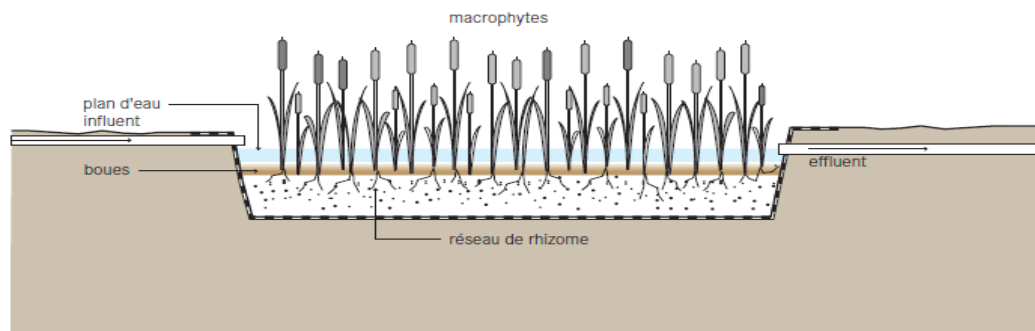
coupe transversale d'un filtre planté horizontal à écoulement superficiel.
